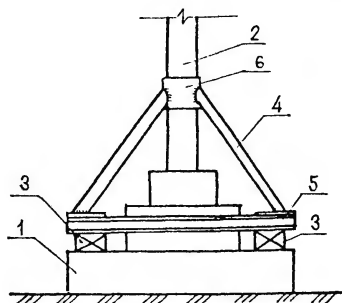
Передача части нагрузки от колонны на обреза фундамента
